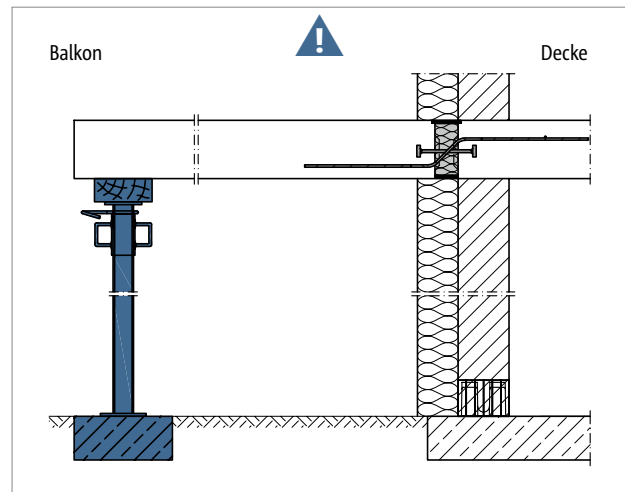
Schöck Isokorb® T Typ QP: Stützung durchgängig erforderlich
